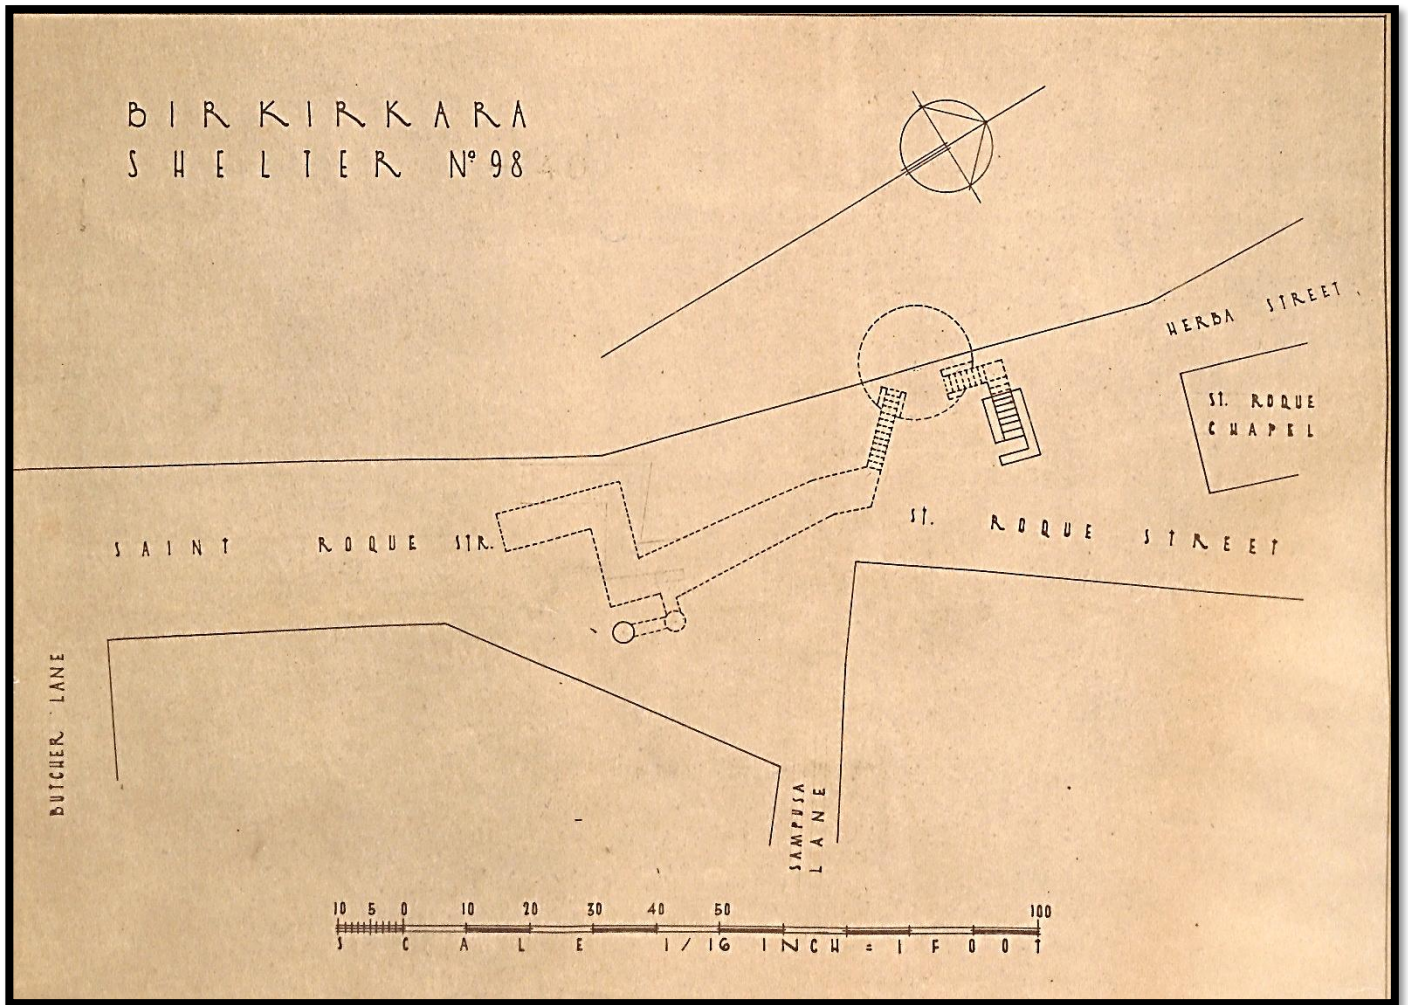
Planta do Abrigo nº 98 (40) "Butcher Lane – Saint Roque Str. – Herba Street"
